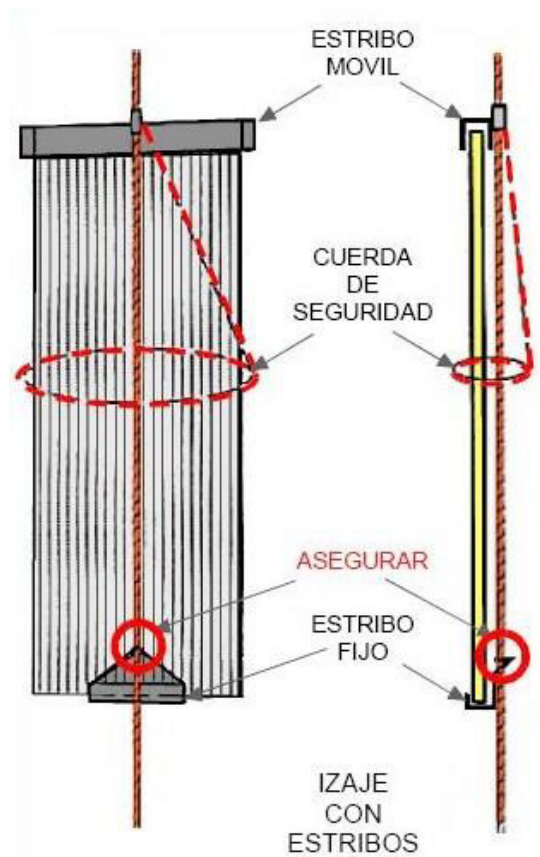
Izaje con estribos (Fuente: METCOL)
